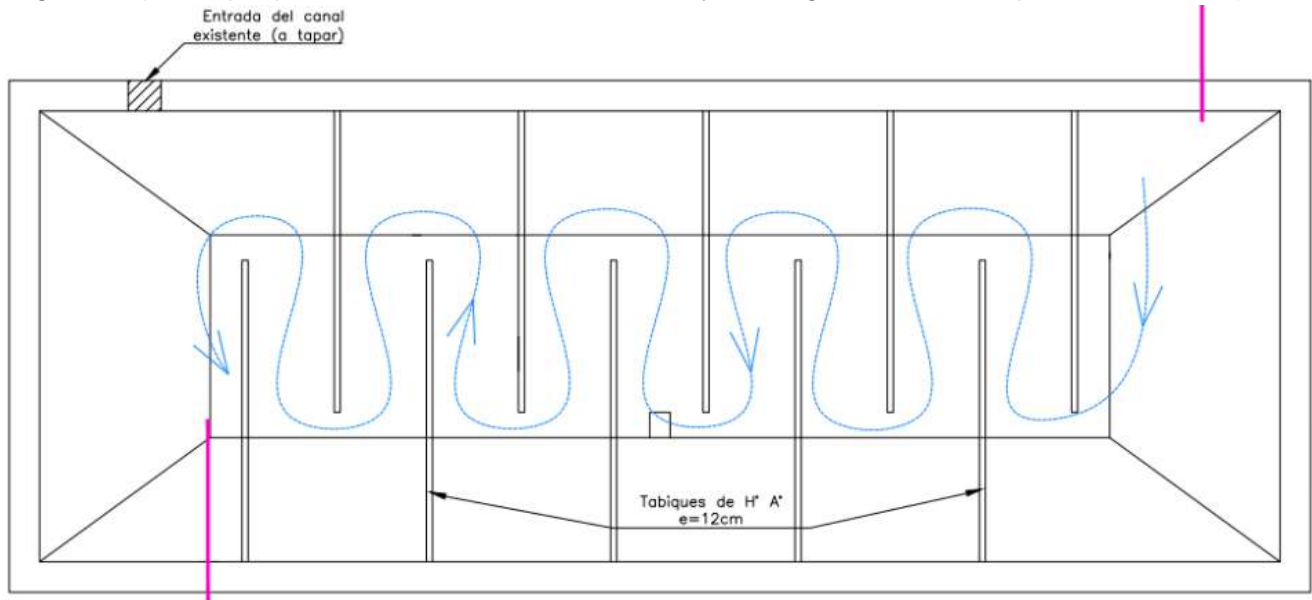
Ubicación de los tabiques deflectores – Fuente de elaboración propia
